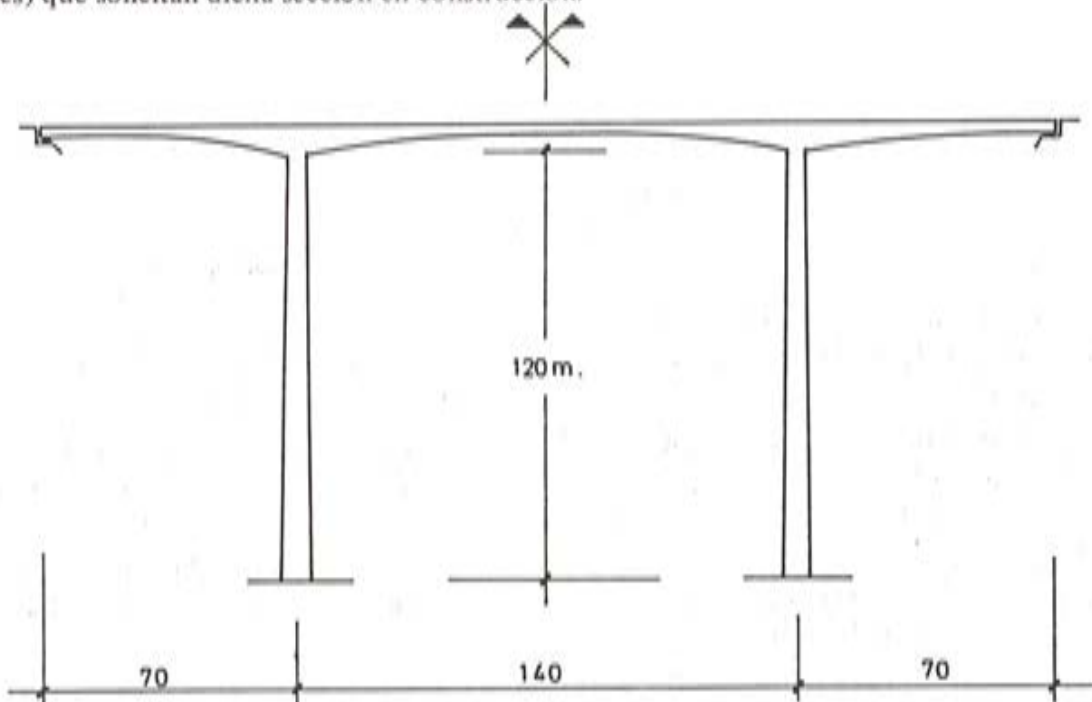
Alzado longitudinal del viaducto analizado en primer lugar, con luz principal del dintel de 140 m y pilas de 120 m de altura.
